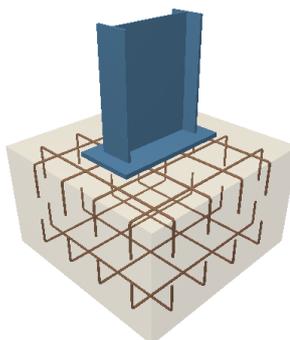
Zapata Z2. Fuente: CYPE 2017
